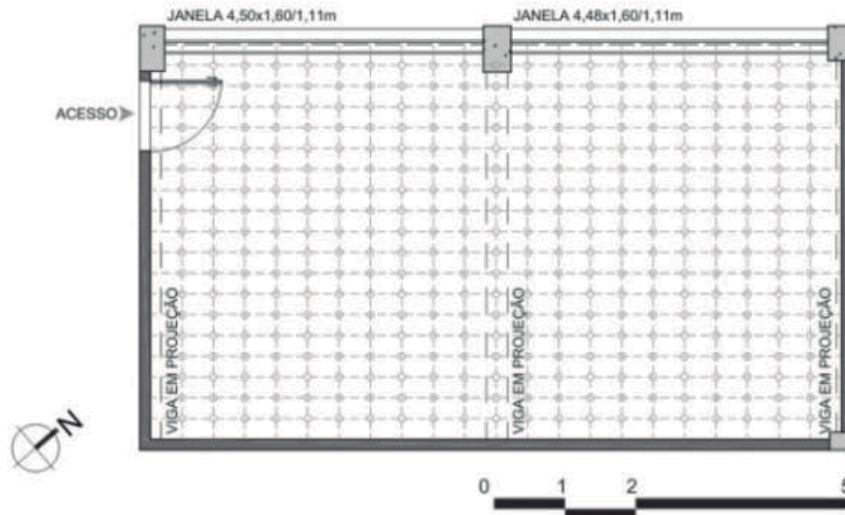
Planta Baixa do modelo virtual utilizado para a produção das simulações.
